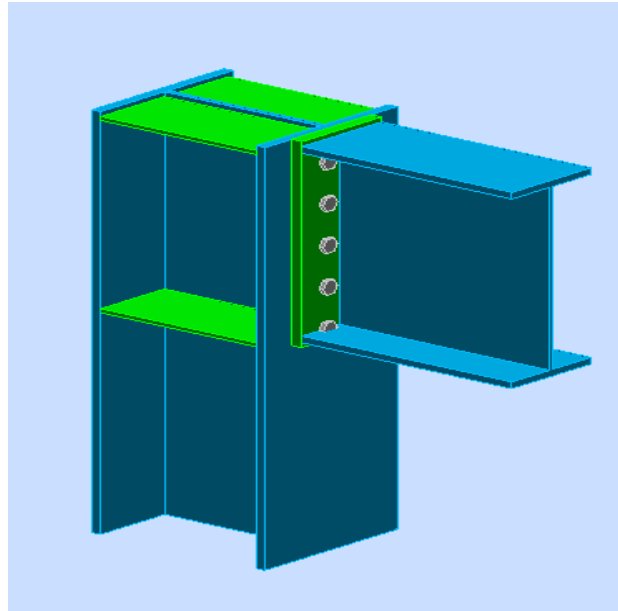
Vue 3D de l'assemblage poutre-poteau
